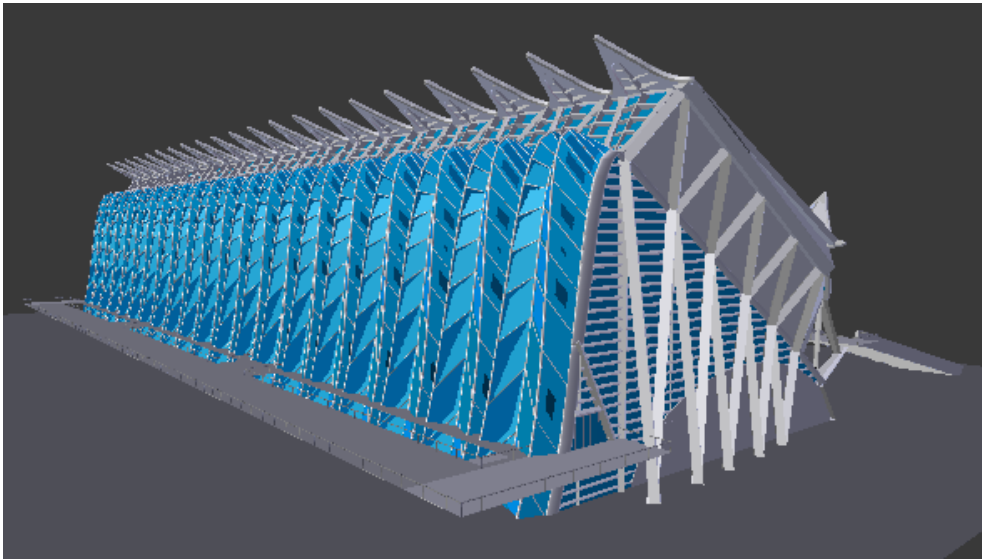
Modelado en Blender, fachada noreste finalizada
